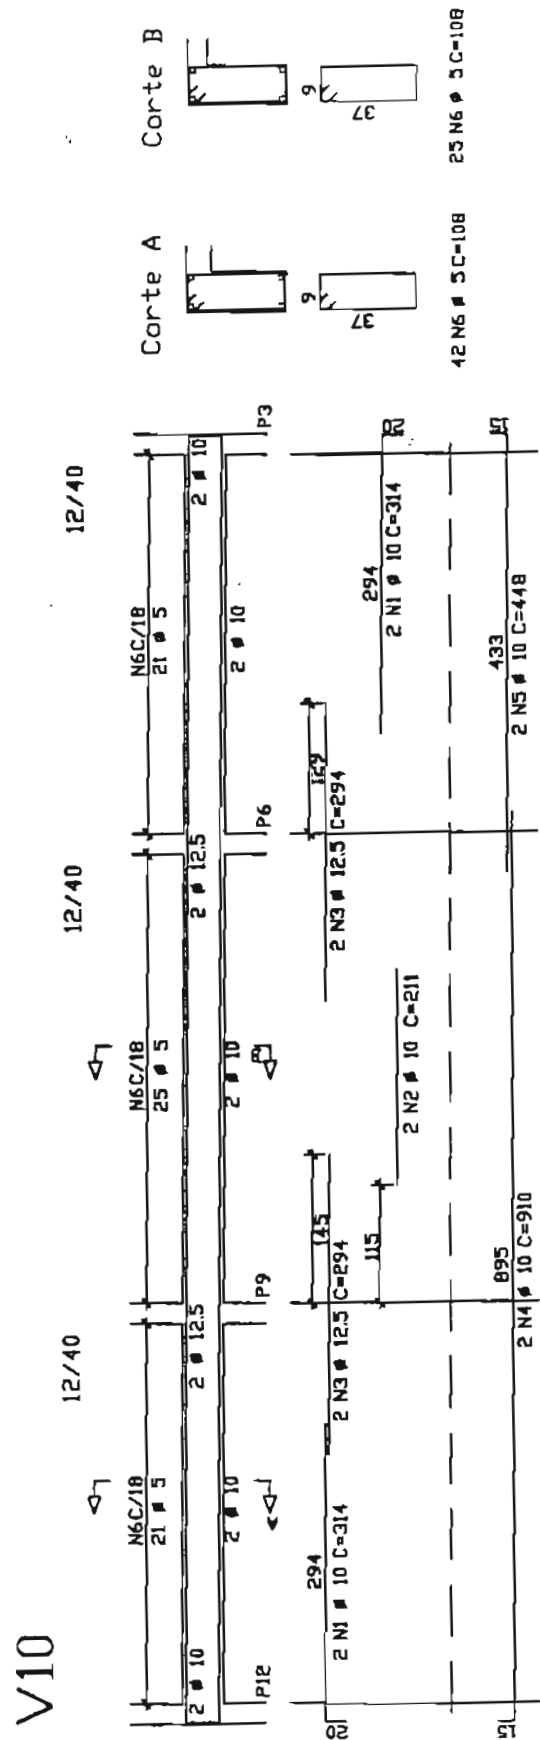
Detalhe de armadura da viga V10 (viga continua)
